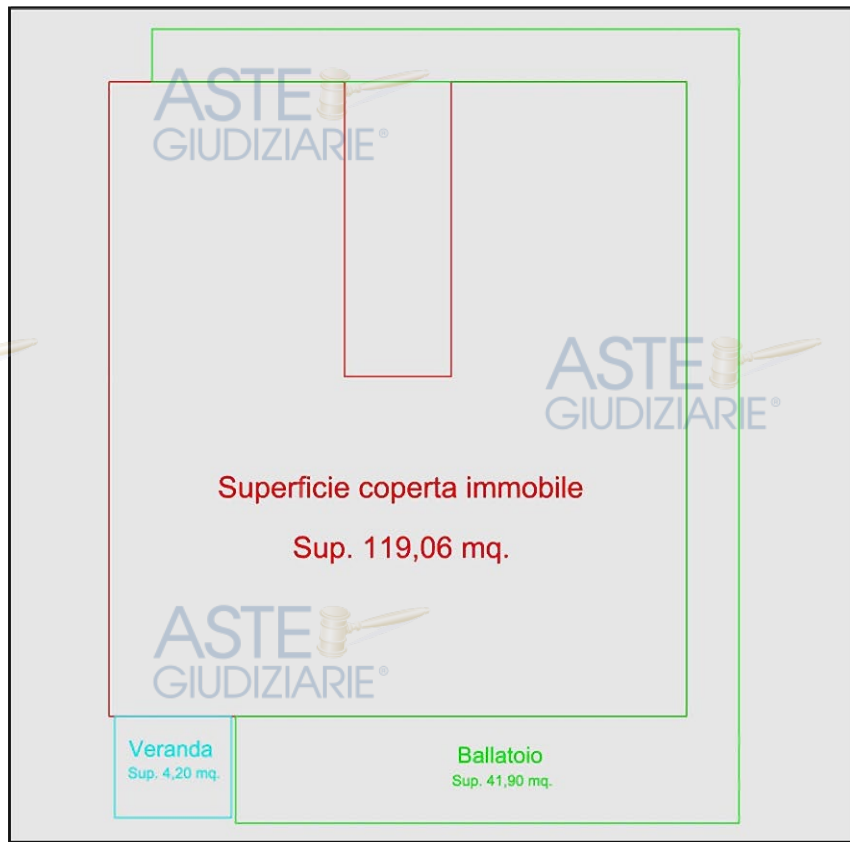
Visualizzazione della planimetria con indicazione delle superfici coperte
